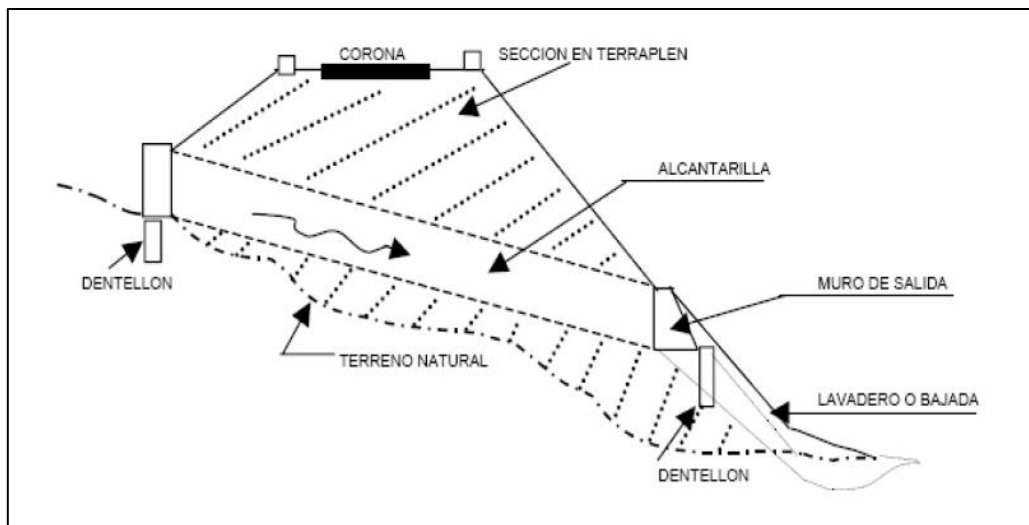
Perfil de una Alcantarilla. Colocación en Terraplén
